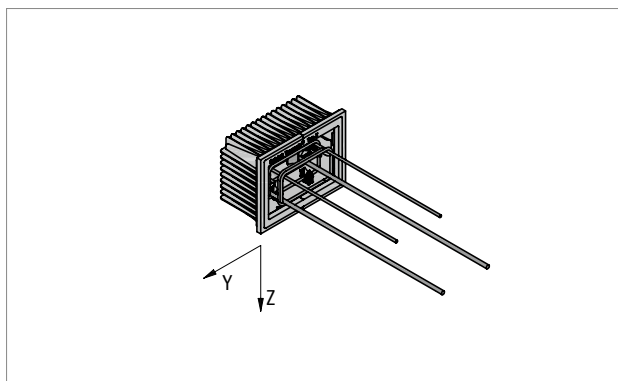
Schöck Tronsole® typ Z: Půdorys úložné konzoly se zabudovaným armokošem
